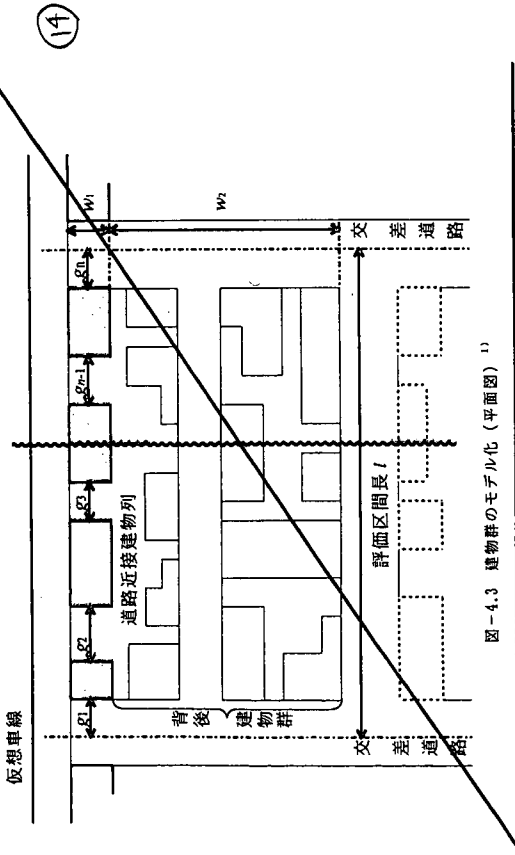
建物群のモデル化（平面図）<sup>1)</sup>
